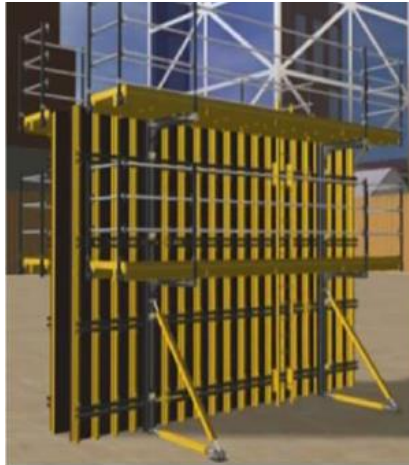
Instalación de la primera tongada. Recuperado de: Ulma Construction.
